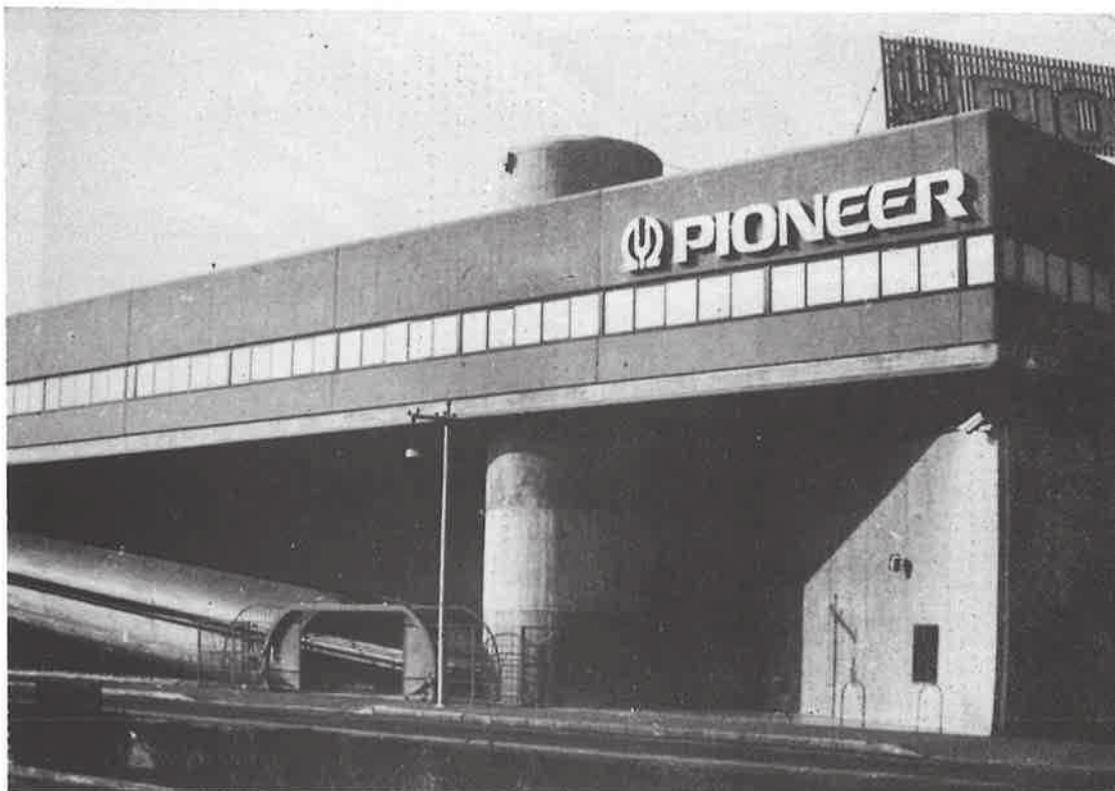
esempio di piastre incorporate in una struttura complessa in parte a sbalzo - rif. IV
